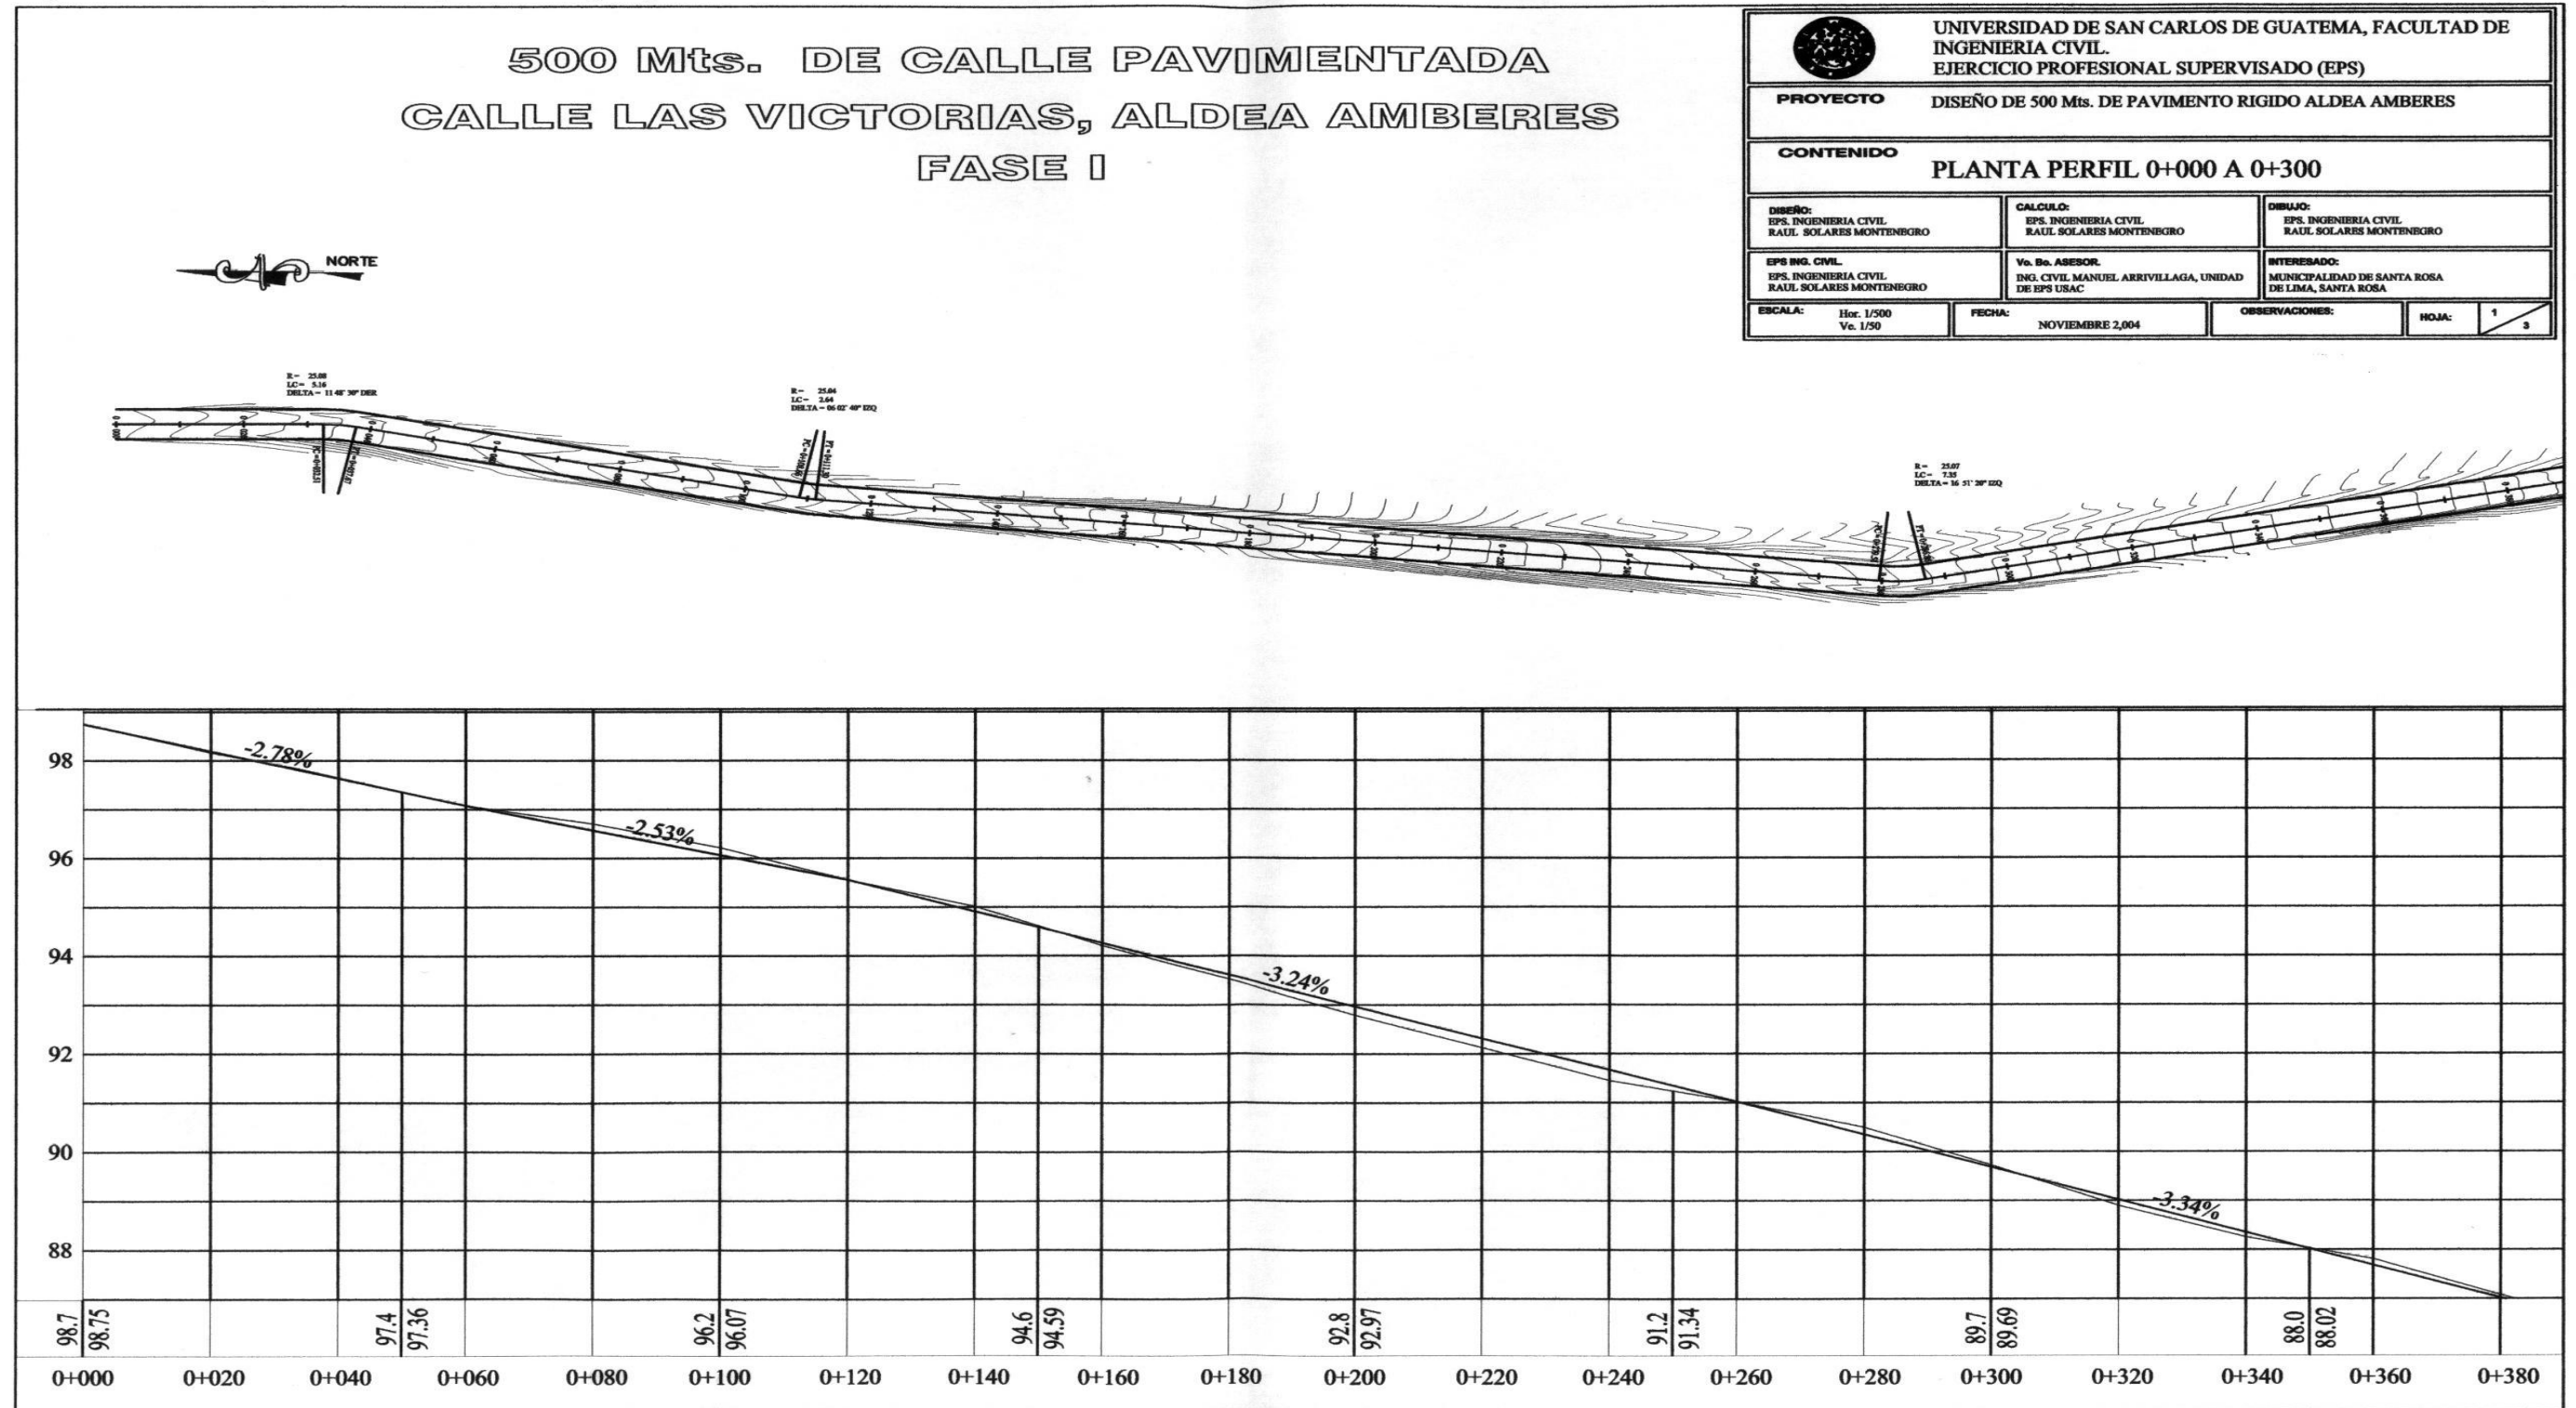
Plano de planta perfil de pavimento rígido primera fase
